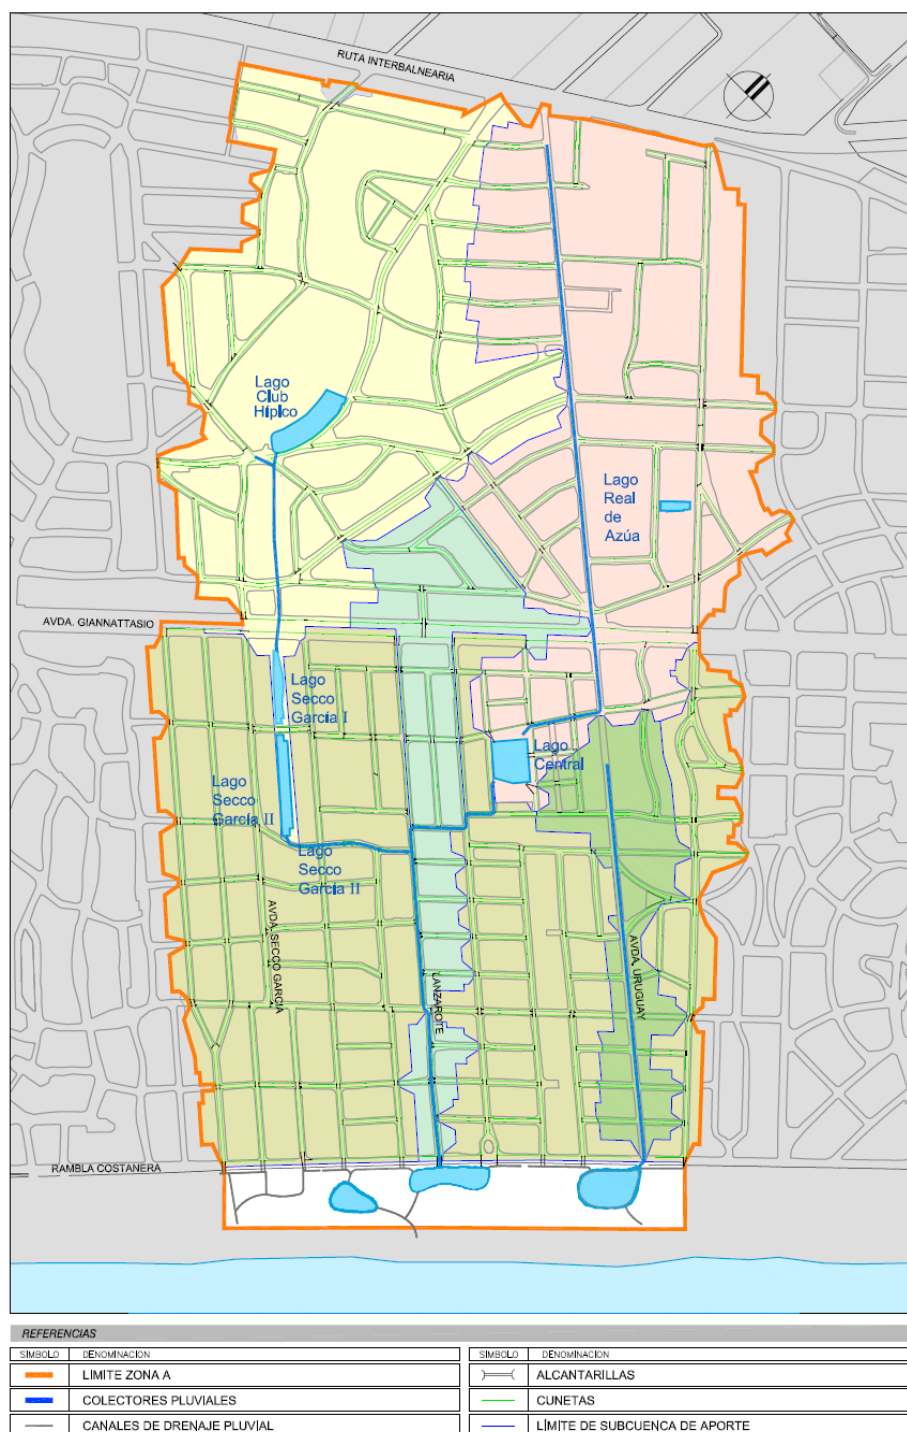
Esquema general del sistema de drenaje pluvial
